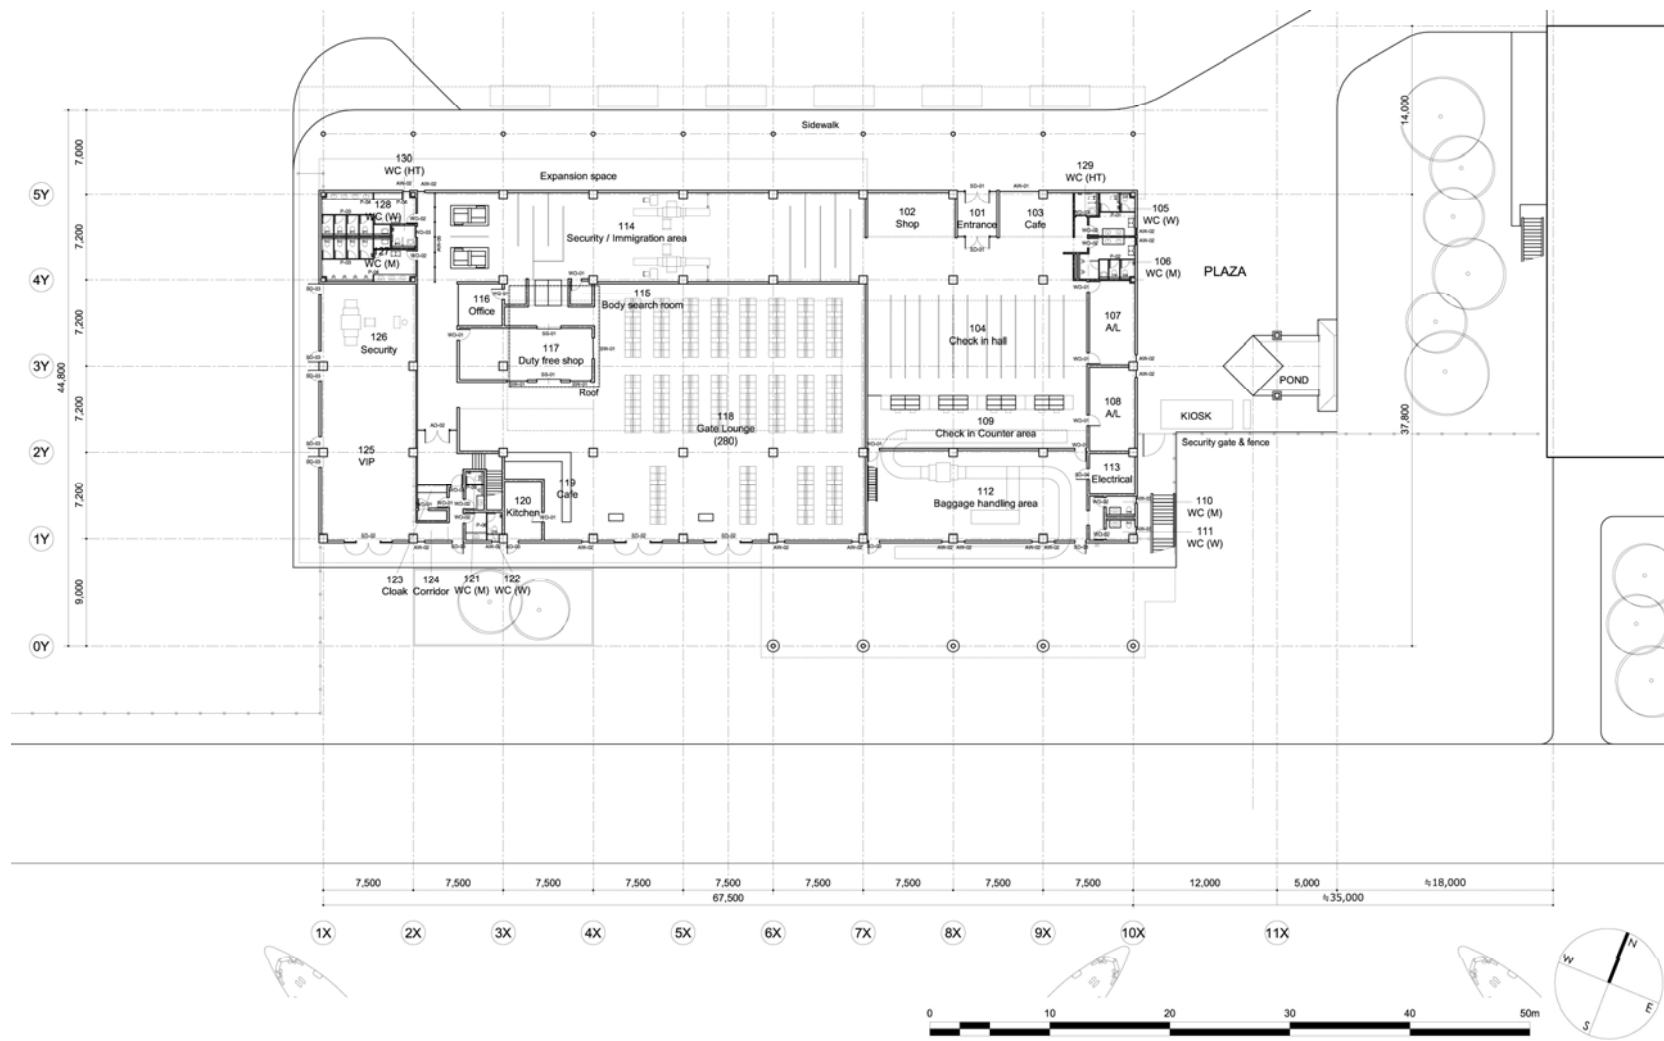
国際線出発ターミナルビル (IDT) 1階平面図
